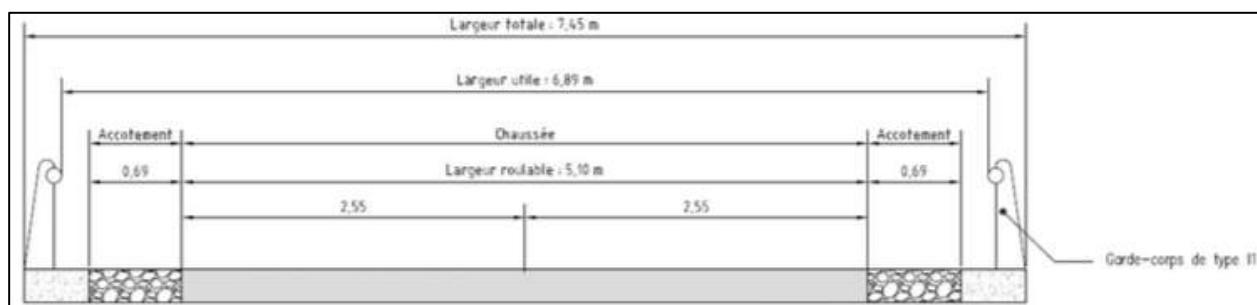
Vue en travers de l'ouvrage Fiori (source : DEPS, 216)
